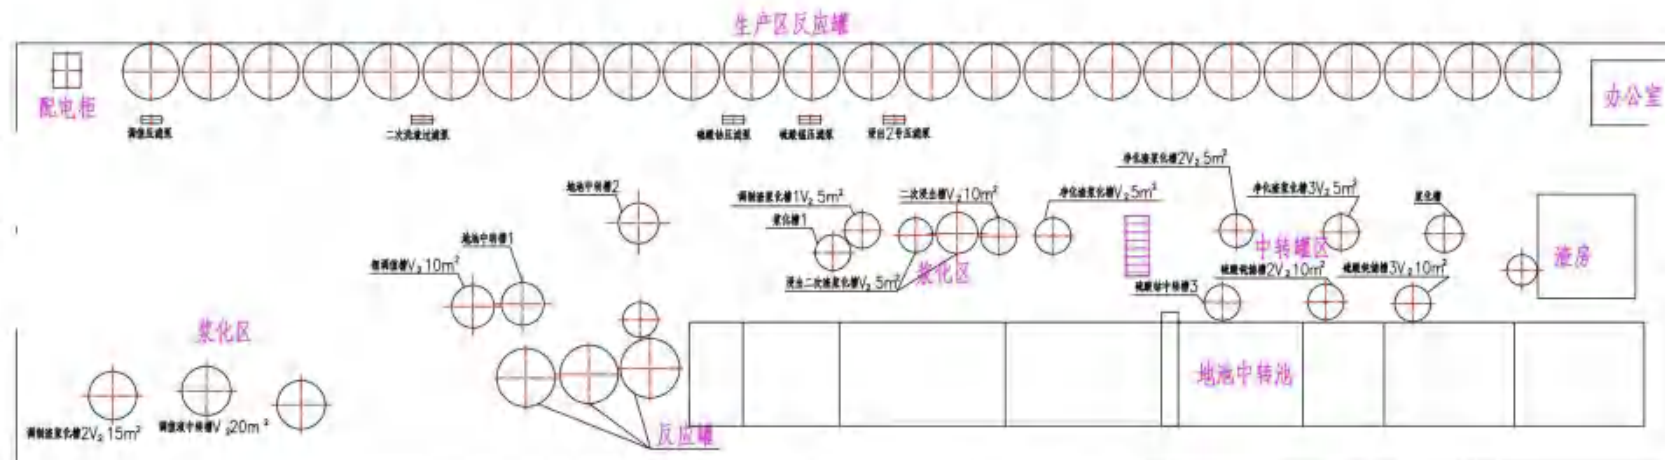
浸出一车间设备设施平面布置图 (1 楼)
